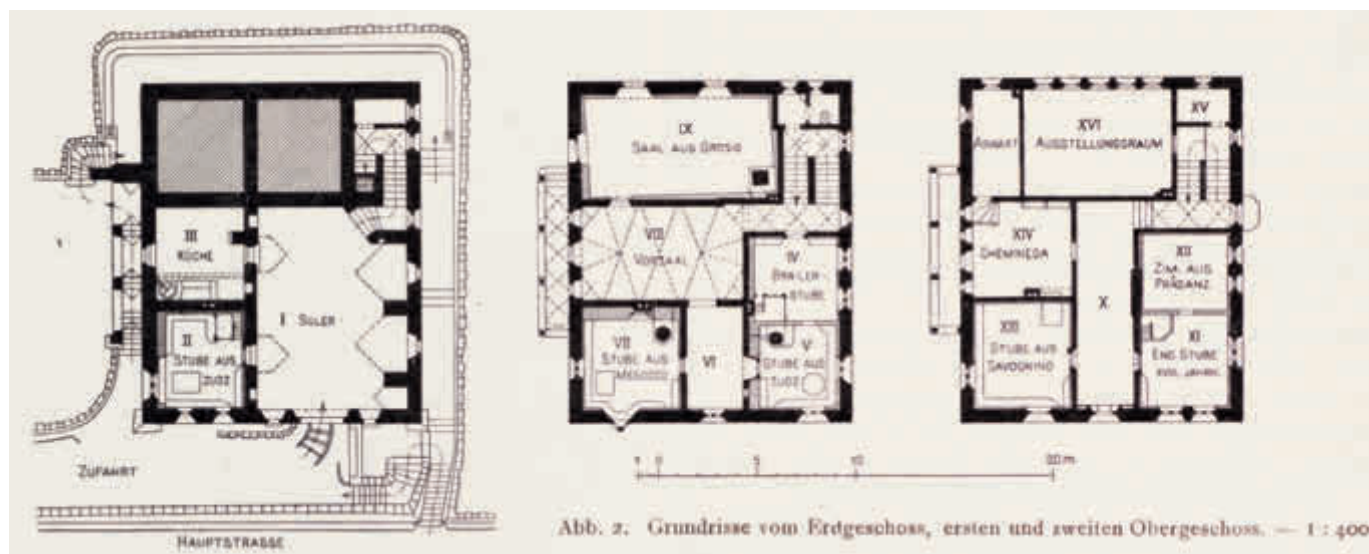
Grundrisse vom Erdgeschoss, ersten und zweiten Obergeschoss. — 1: 400.
